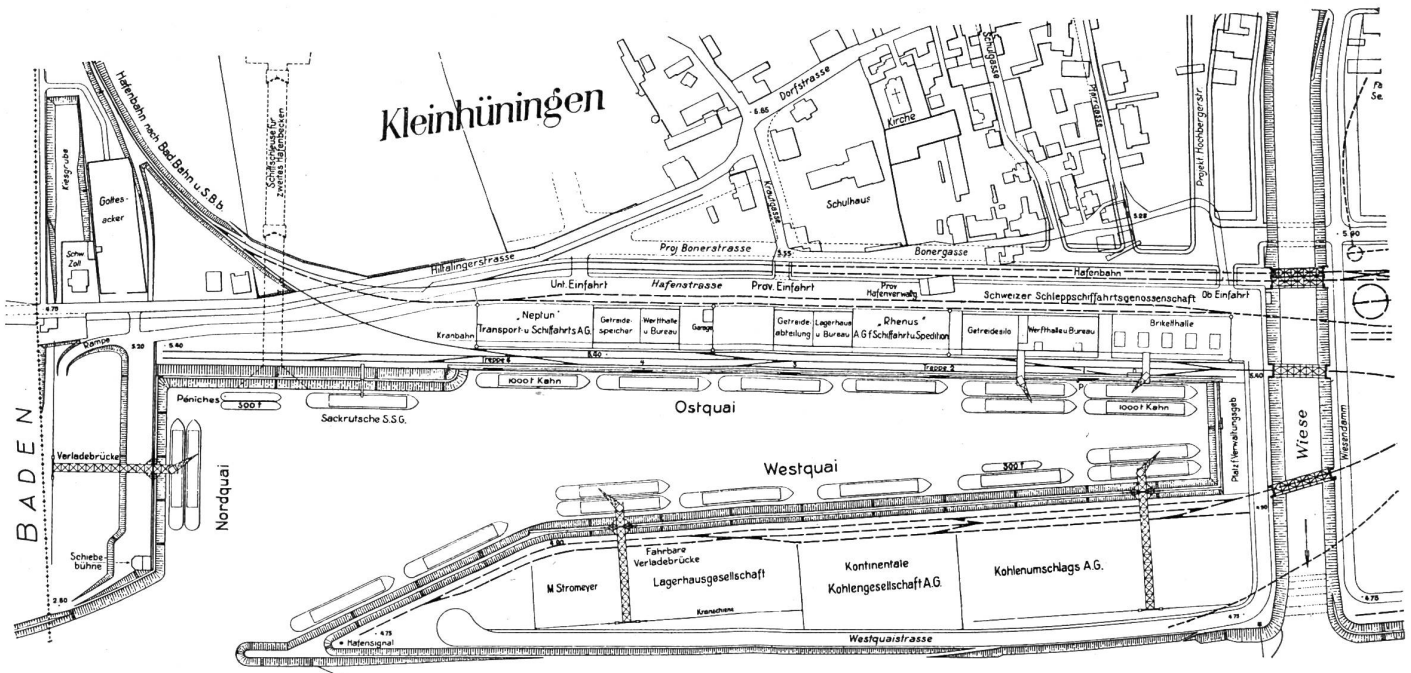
Lageplan 1:4500 des Hafenbeckens Kleinhüningen (Gestrichelte Geleise im Bau).
